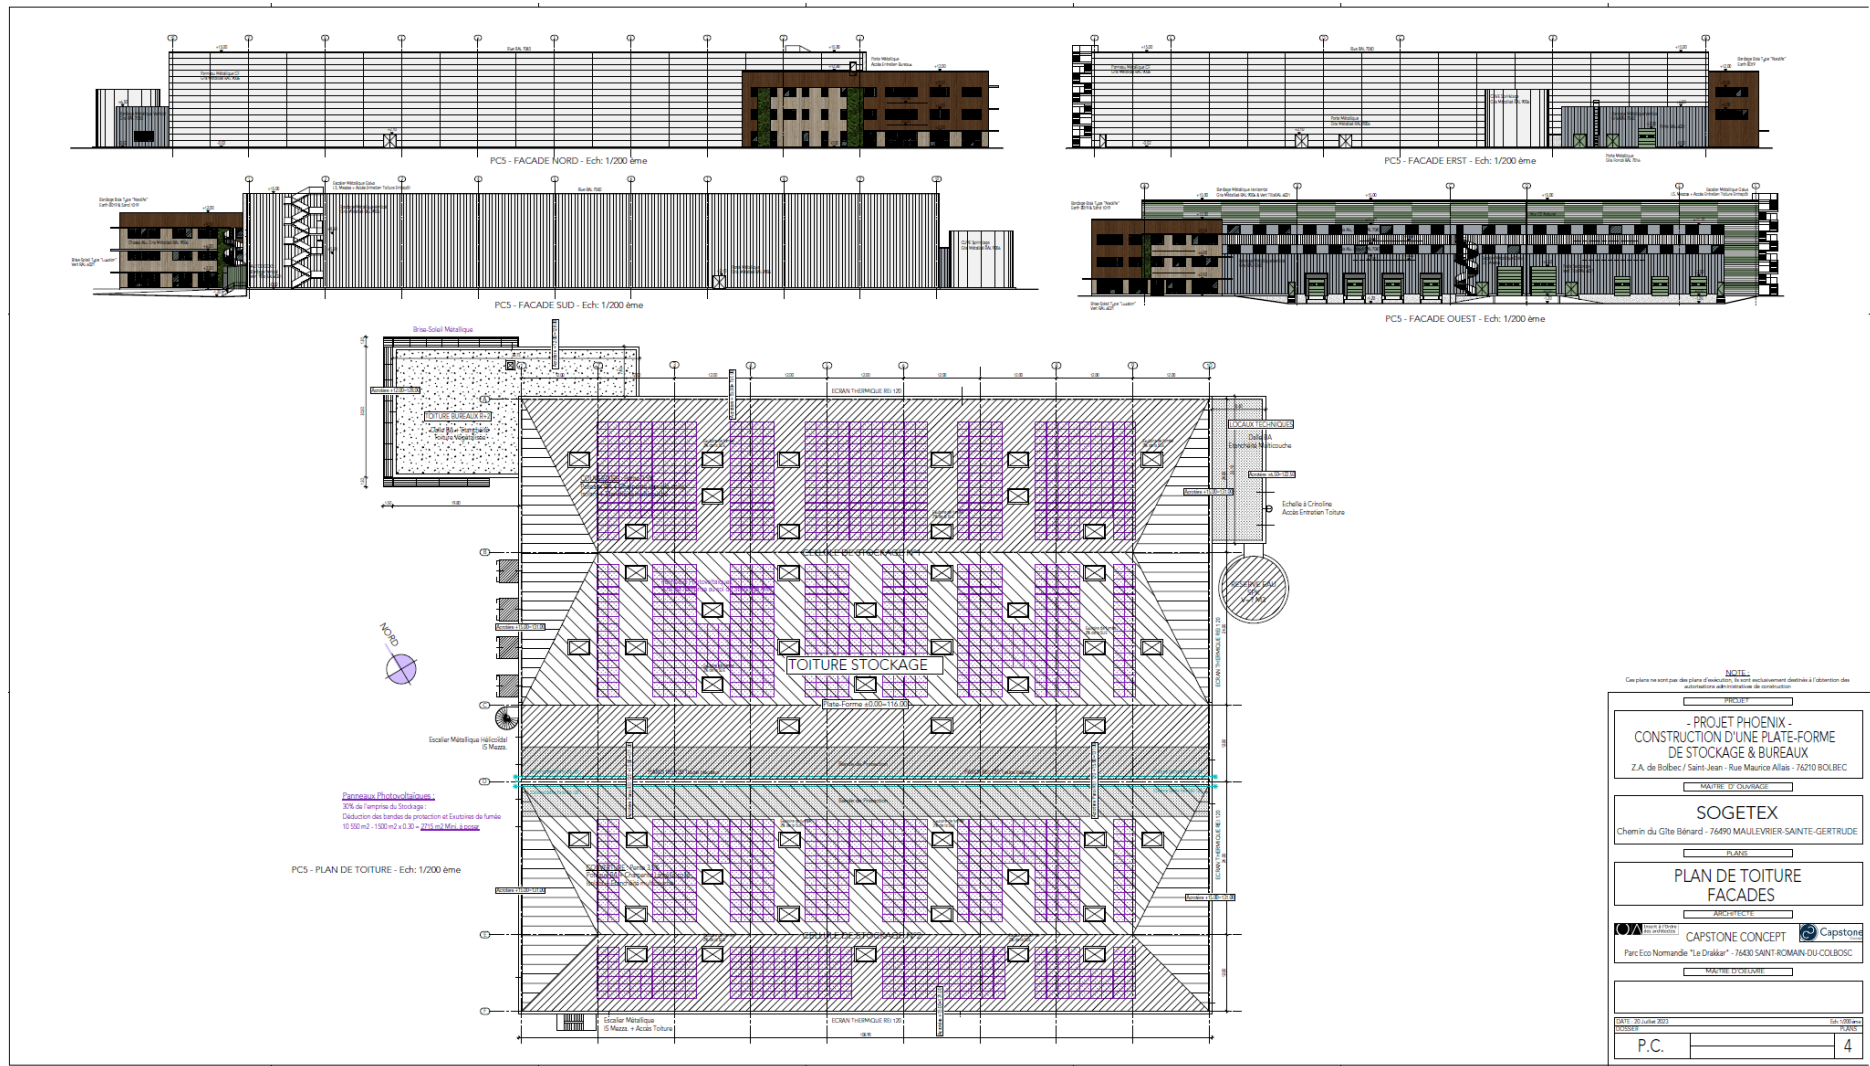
Plan de toiture et des façades (source : CAPSTONE CONCEPT)
